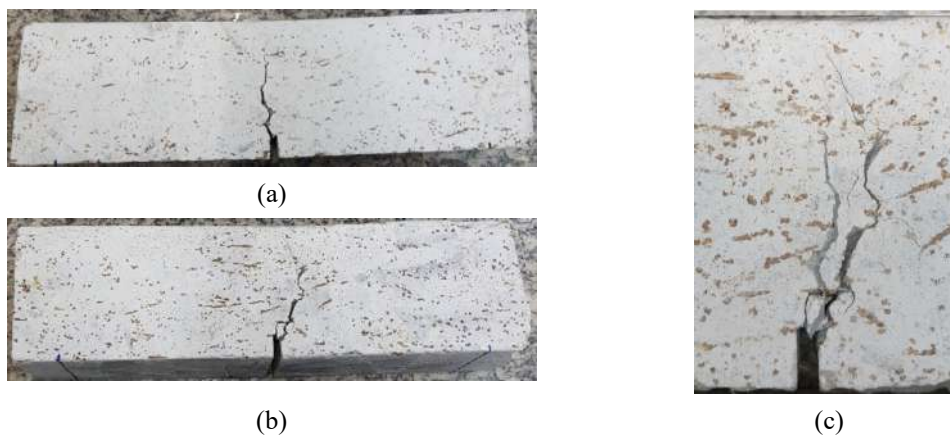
Assimetria do padrão de fissura em corpos de prova prismáticos com dimensões 9x9x 32 cm³: (a) frente do corpo de prova, (b) verso do corpo de prova, e (c) sobreposição das fissuras.
